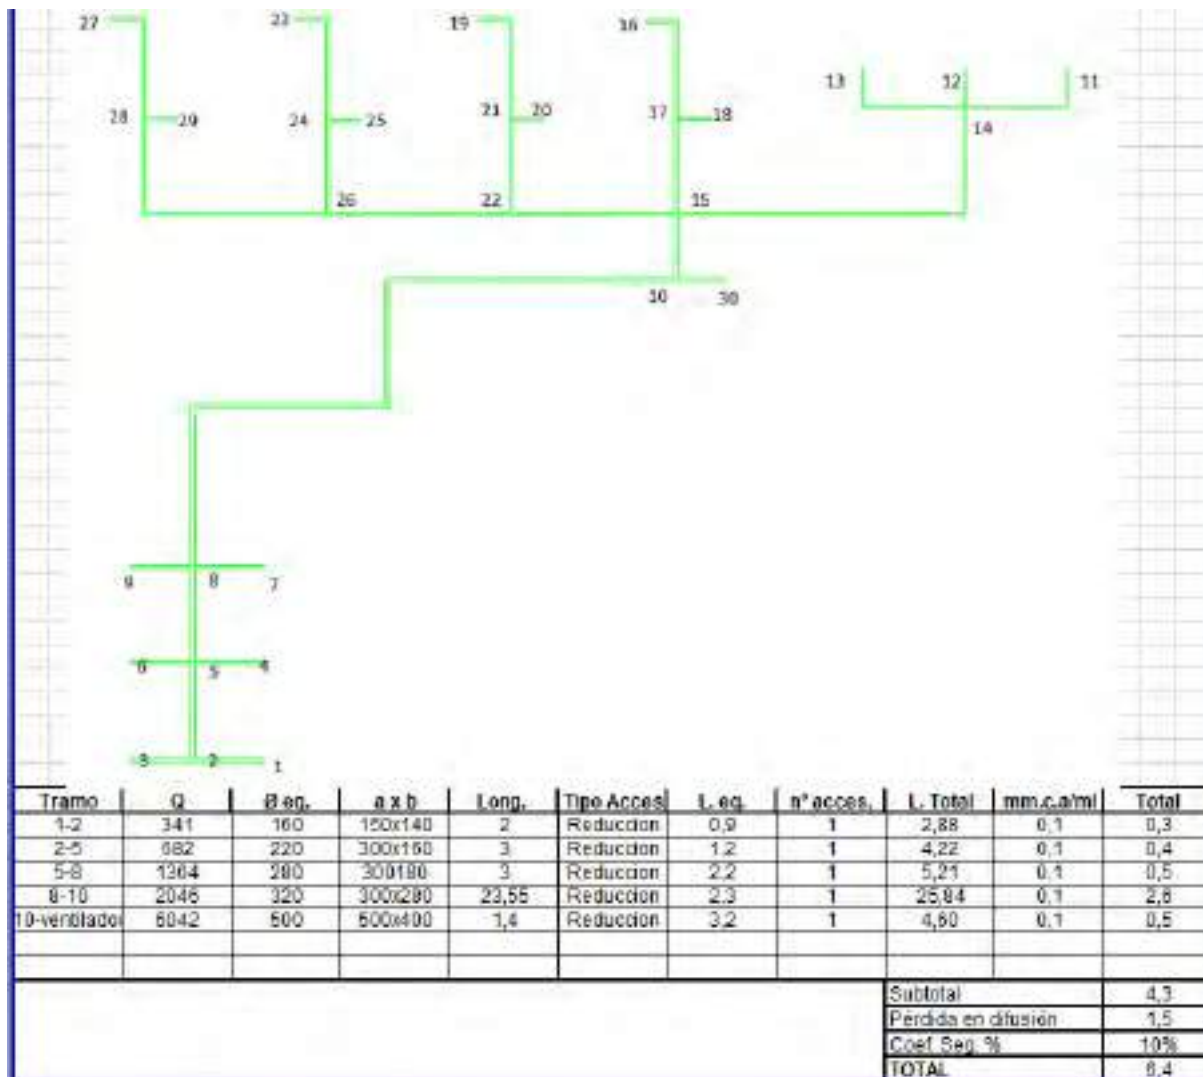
Conductos planta segunda. Tramo más desfavorable.
